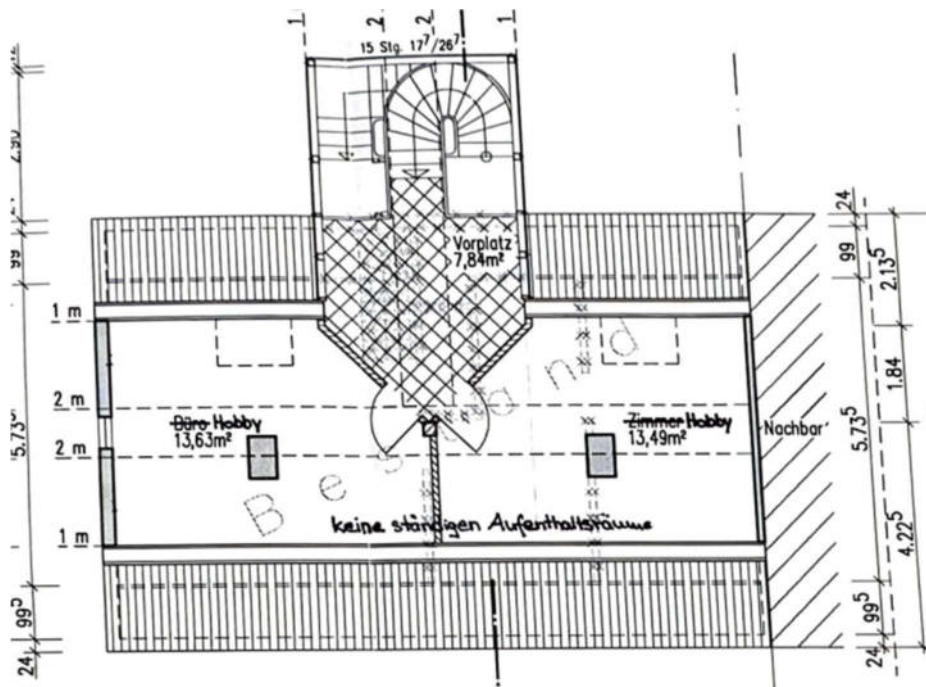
Grundriss Dachgeschoss (Bauunterlagen 2006)
